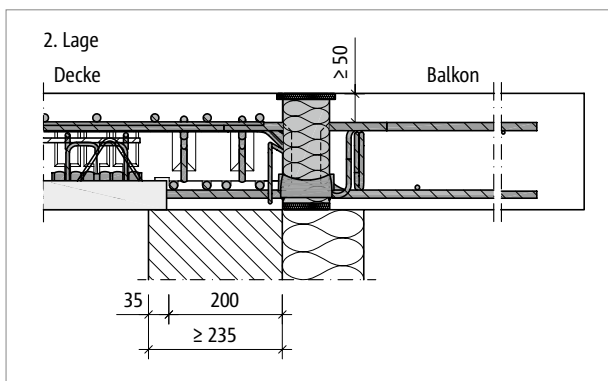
Schöck Isokorb® T Typ C: Halbfertigteilplatte ohne Randunterstützung mit WDV (Schnitt T Typ C-CV50-2. Lage, Ansicht T Typ C-CV35-1. Lage)
